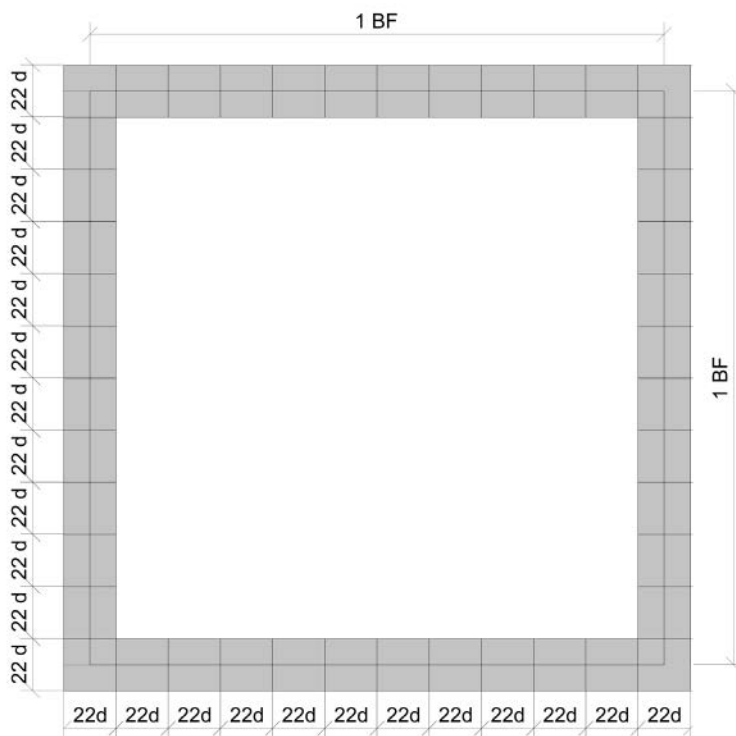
Dimensionamento dei quadrati della pavimentazione.
